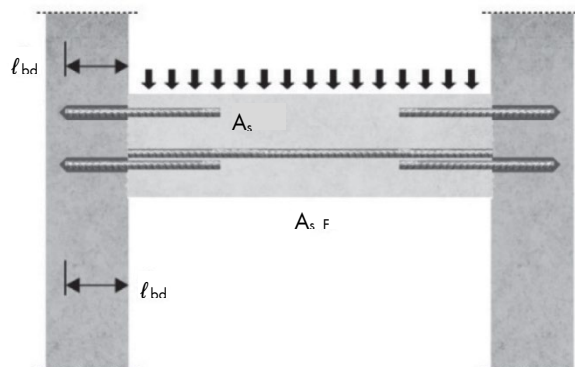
Краявое крепление плит или балок, спроектированное как простая опора
